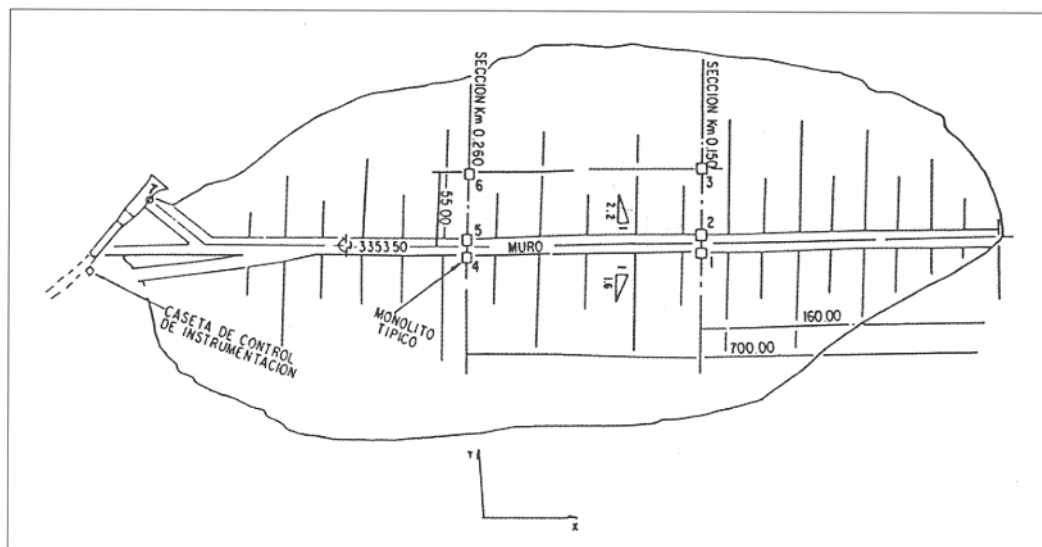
Plano en planta a escala 1 :2.800 del muro del embalse y ubicación de los puntos de control
